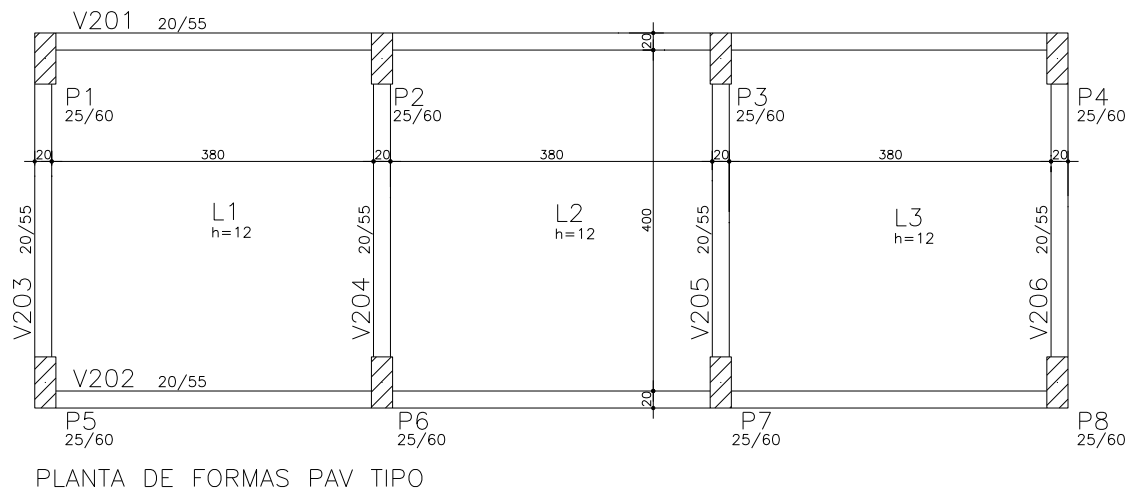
Planta de formas do pavimento tipo: T1 -5P2V2
